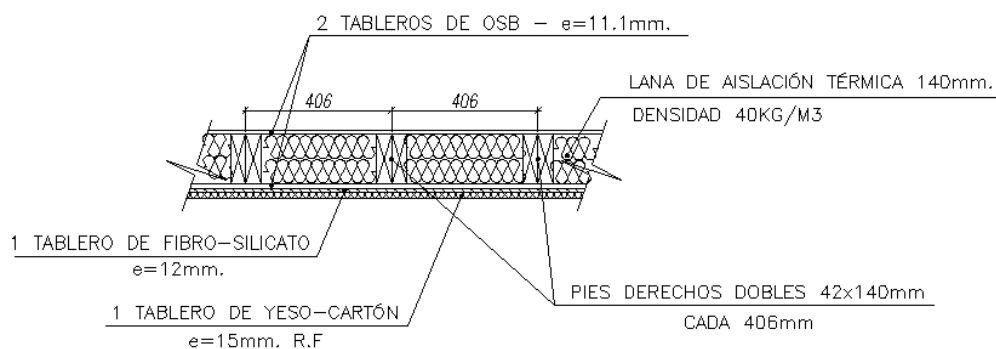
Esquema de Escantillón de paneles de muros longitudinales y transversales en primer piso (revestimiento completo - unidades en milímetros).
